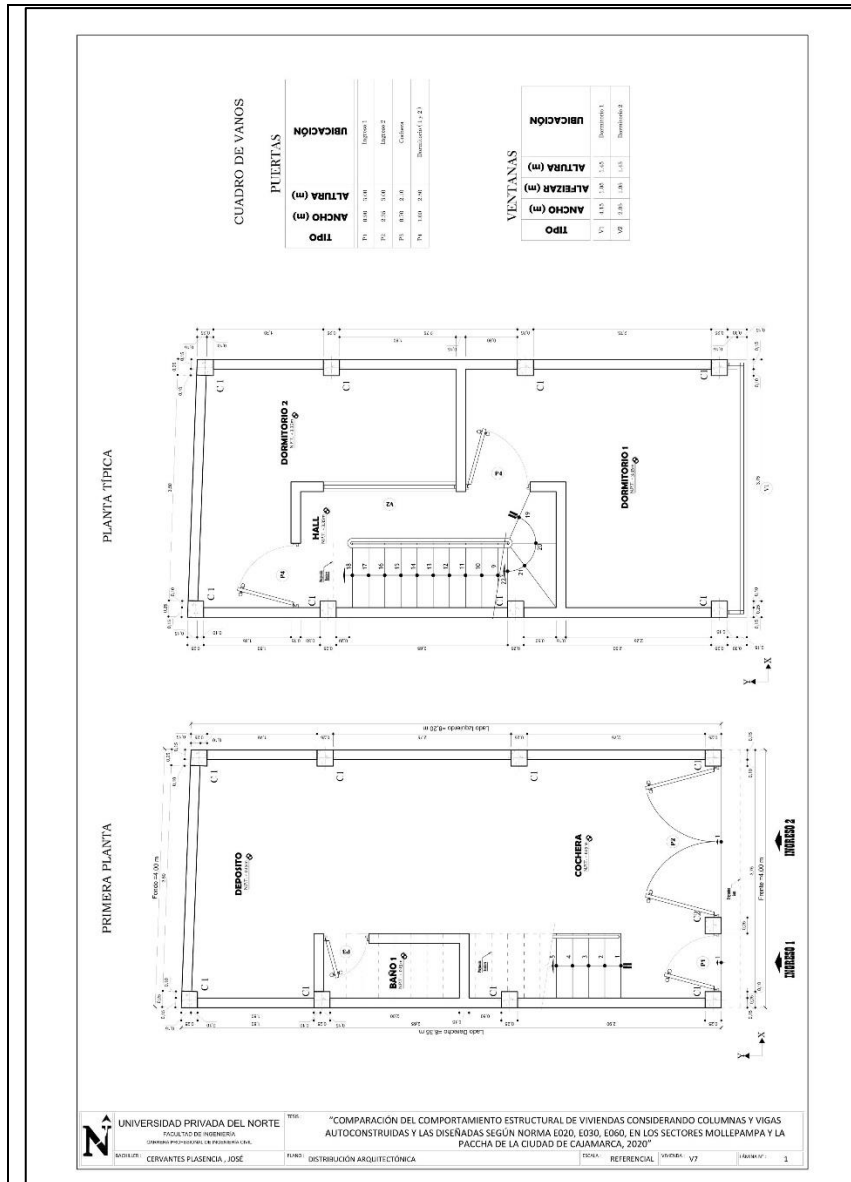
Planos de arquitectura y losa aligerada vivienda 7
